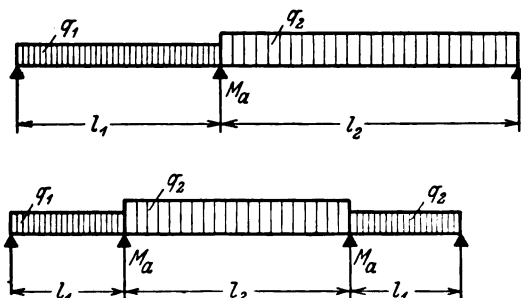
und 8. Durchlaufender Balken mit zwei und drei Öffnungen.
